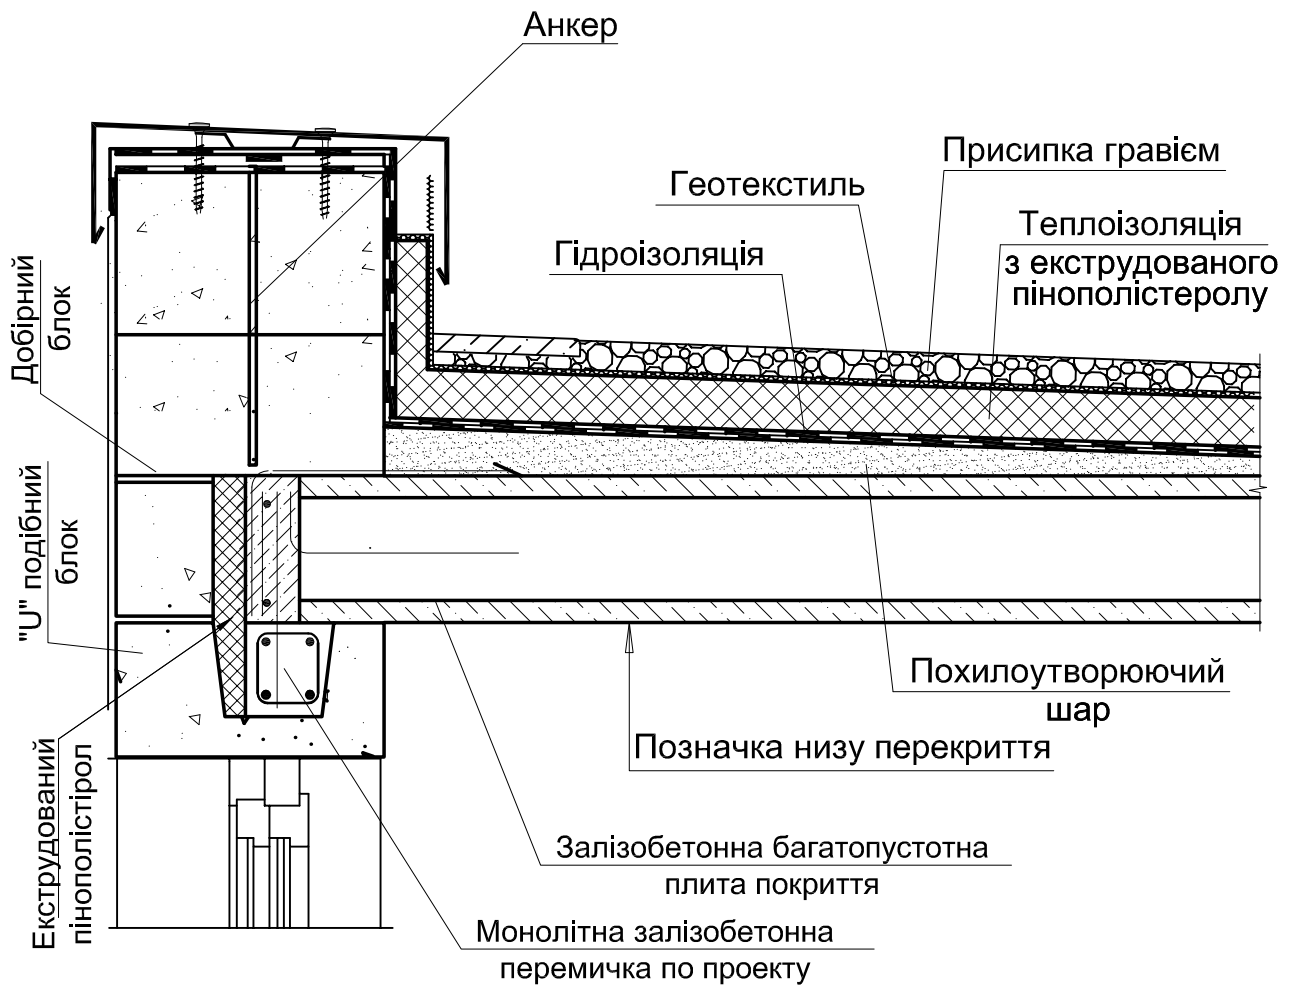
Конструювання утепленого плоского даху над збірним багатопорожнистим перекриттям даху (варіант з низьким парапетом та анкеруванням утеплювача).
